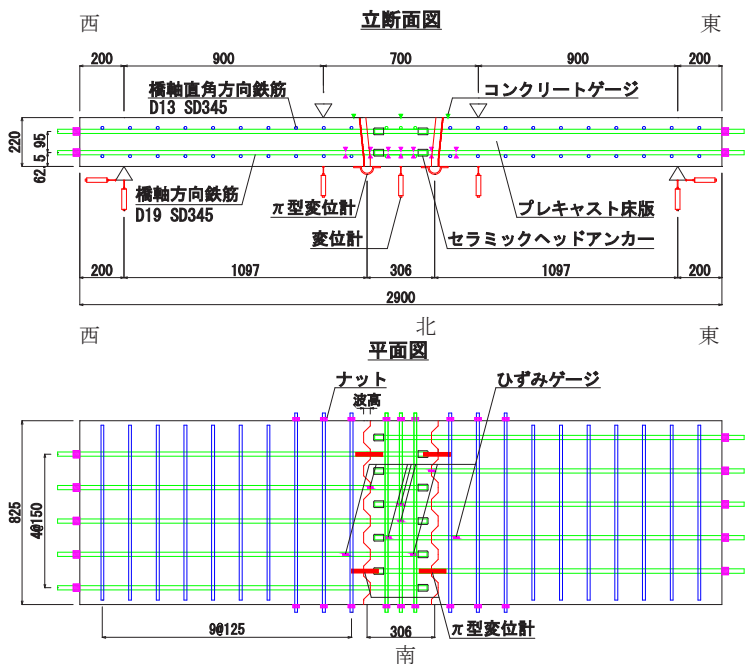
試験体概要及び載荷・計測位置 (Loading and Measurement Position of a Beam Specimen)
